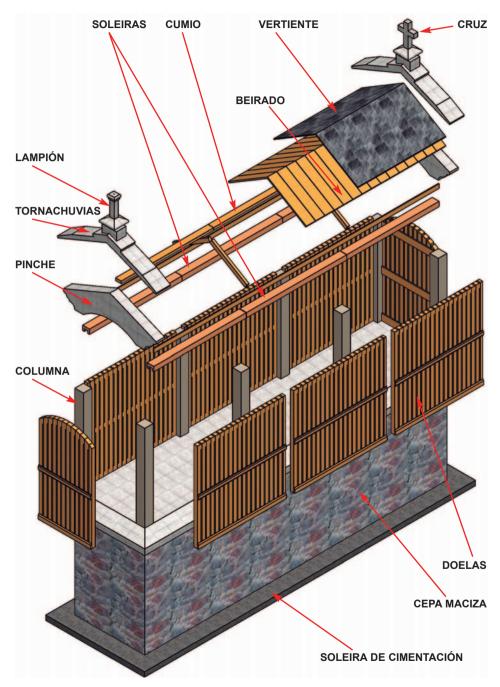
Perspectiva da estrutura construtiva. Fonte propia
